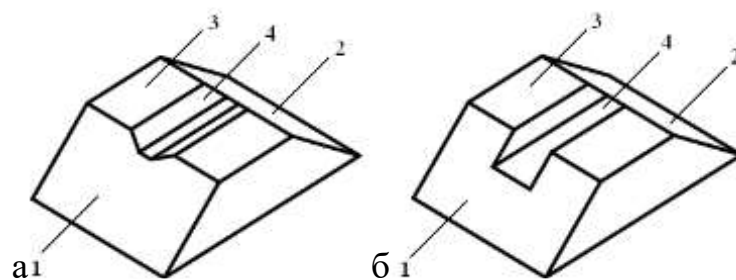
Схемы резервного водосброса в теле грунтовой плотины [29]: а – трапециевидальное сечение; б – прямоугольное сечение; 1 – верховой откос; 2 – низовой откос; 3 – гребень грунтовой плотины; 4 – водослив
